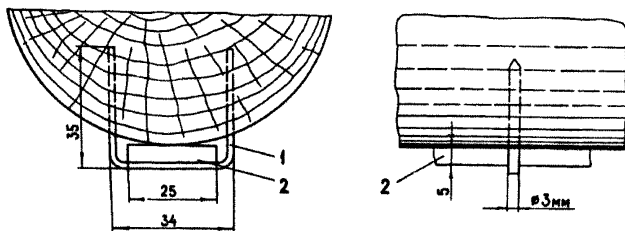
Схема крепления заземляющего проводника в выработке с деревянной крепью:
